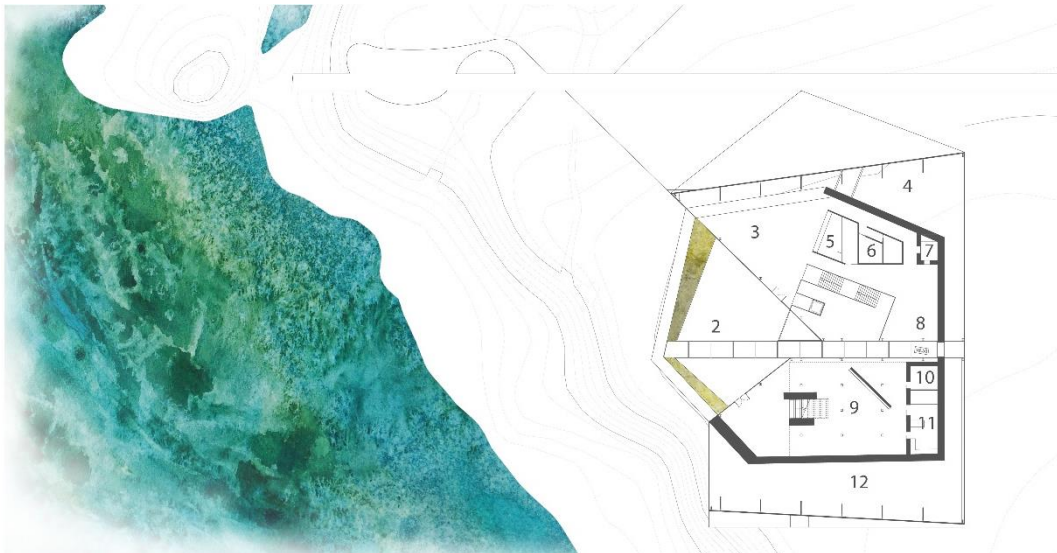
| Planta do piso 0 legendada _ Autor: Marta Crespo
